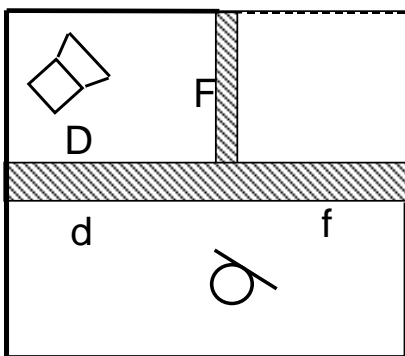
Bezeichnung des trennenden und der flankierenden Bauteile bei versetzten Grundrissen
